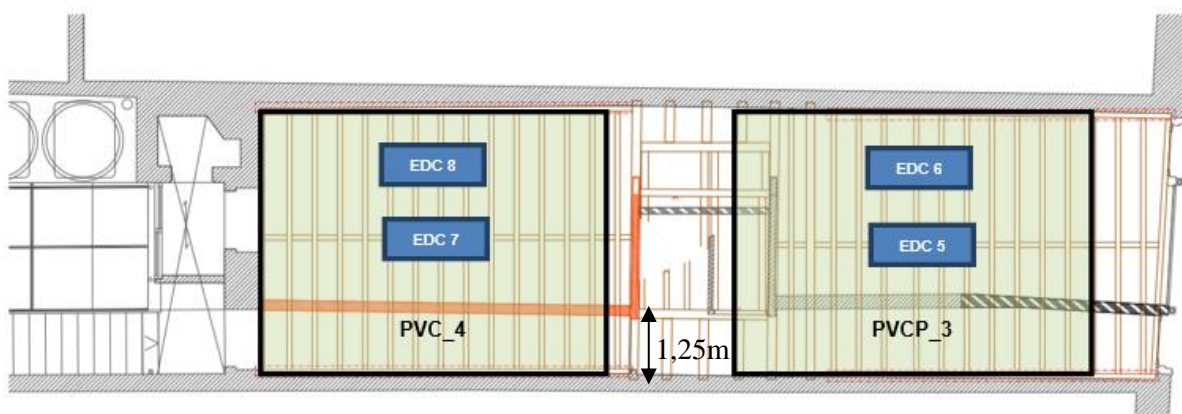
Planta do piso 1, com identificação esquemática dos pavimentos e ensaios dinâmicos
